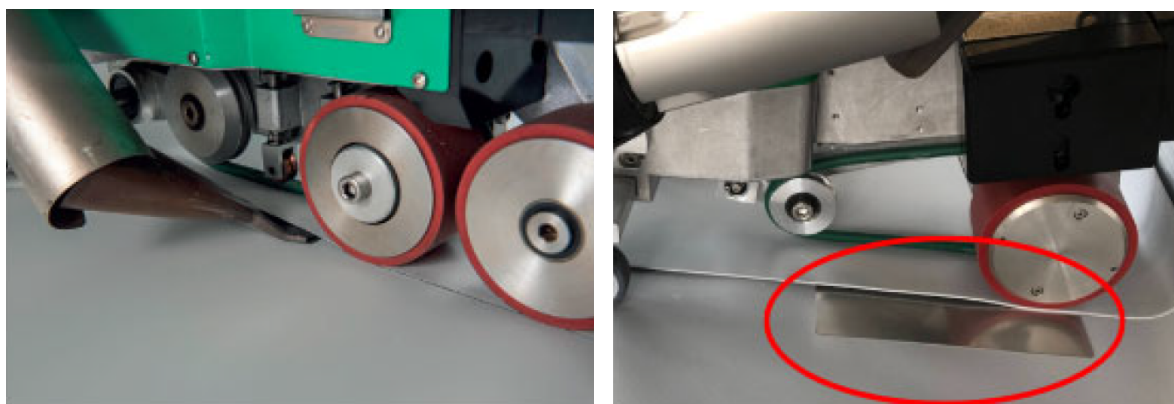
Uso de chapa metálica en transiciones de soldadura automática.
